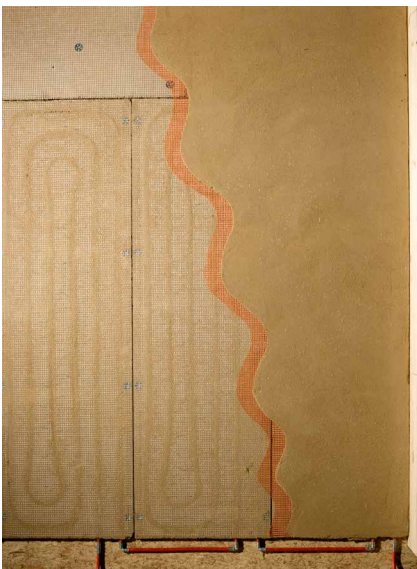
Klimatelement aus Lehm mit integrierten wasserführenden Rohren für die Wand- und Deckenheizung, Putzaufbau mit Armierungsgewebe
